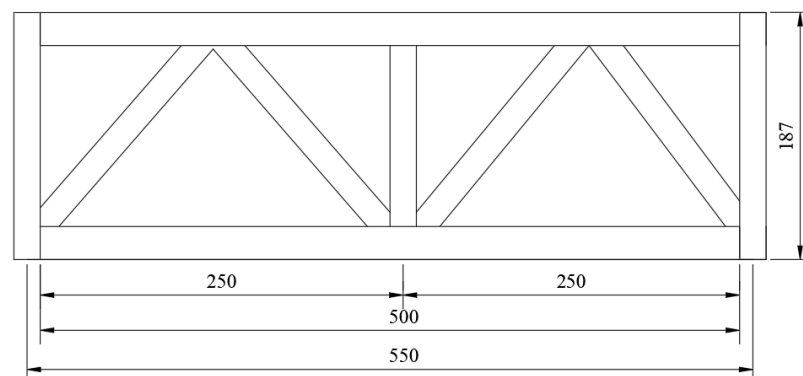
Конструкція фізичної моделі зварної ферми
